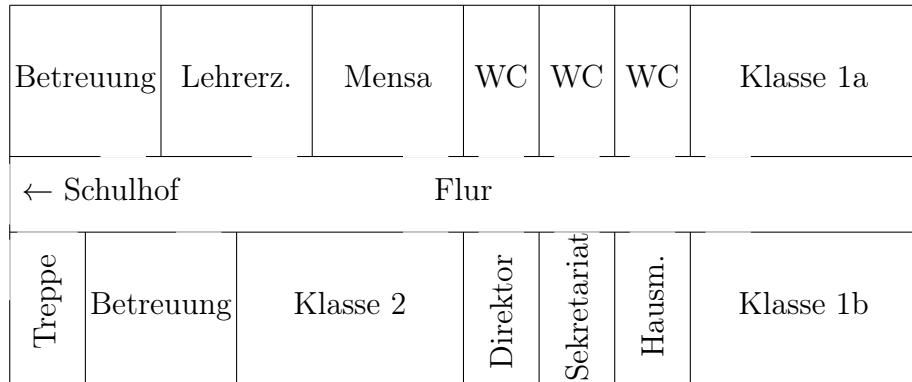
Grundriss EG (nicht maßstabsgetreu) [5]
